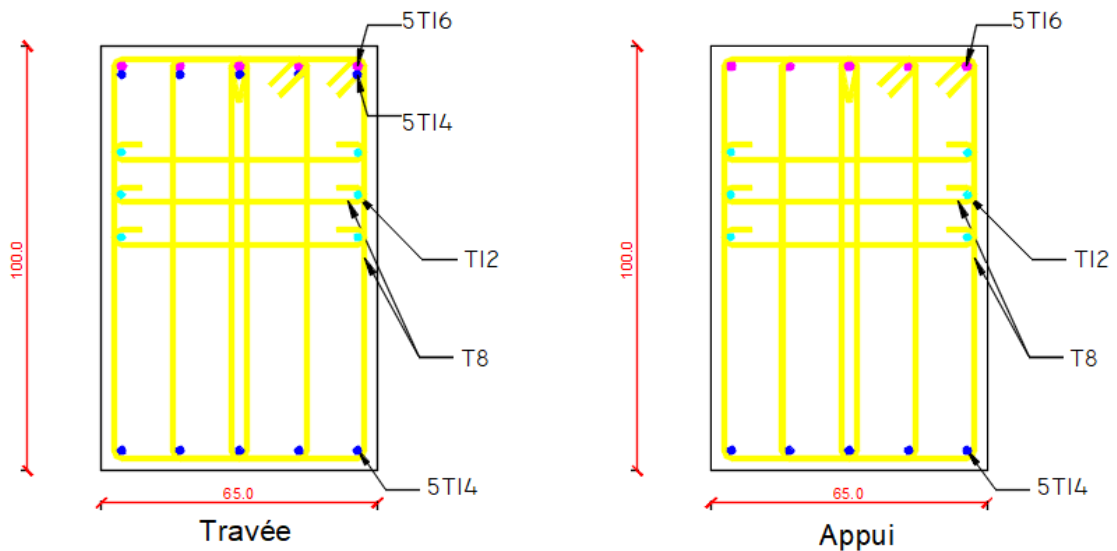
Ferrailage des nervures du sens non porteur.
